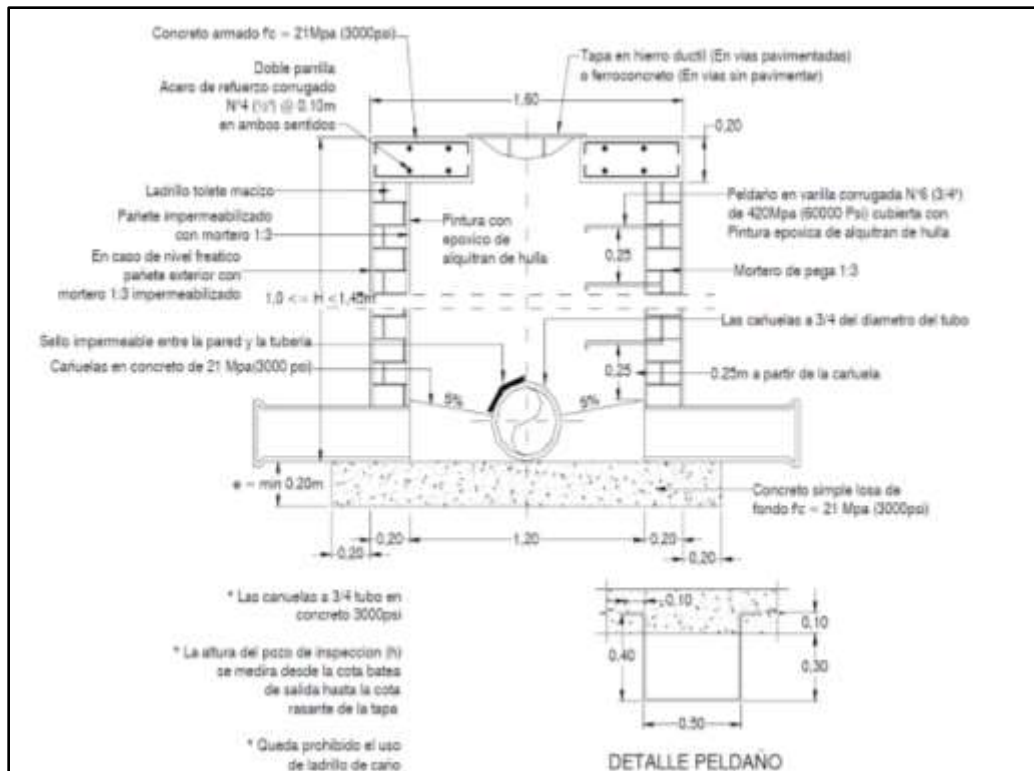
Detalles De Pozos De Inspección 1.0m < H < 1.4m
